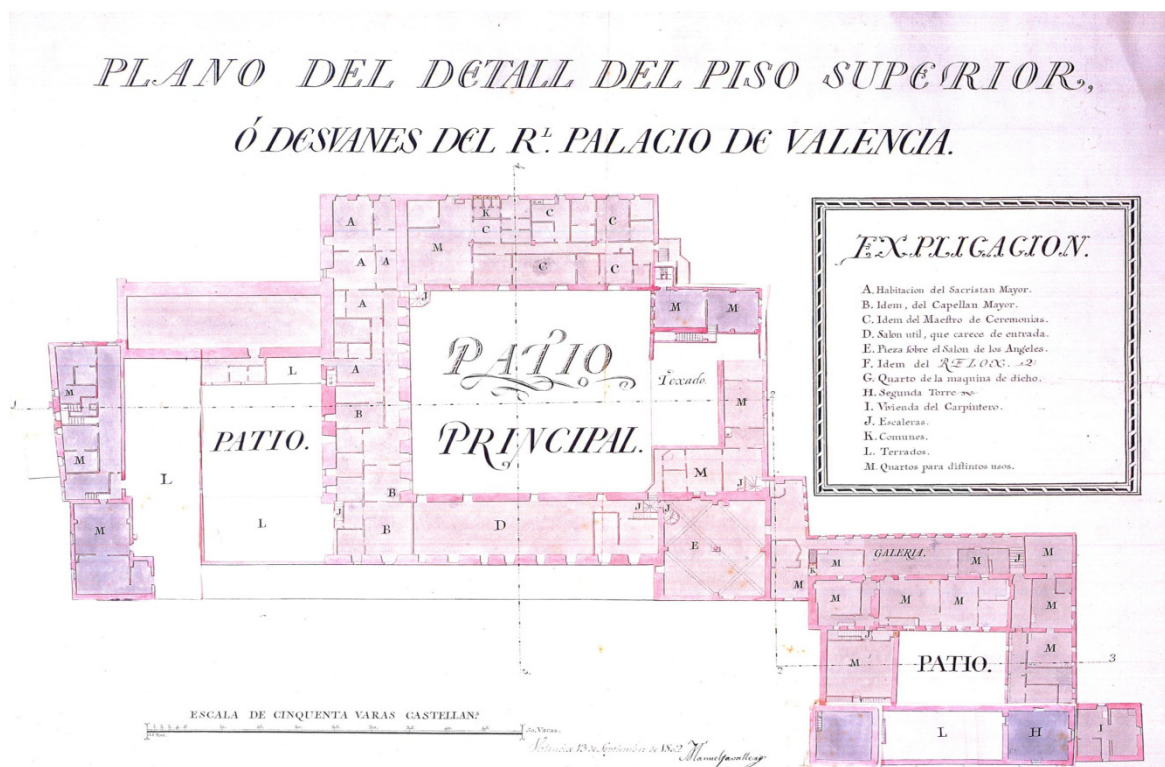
, Plano planta del piso superior. Manuel Cavallero (1802)
